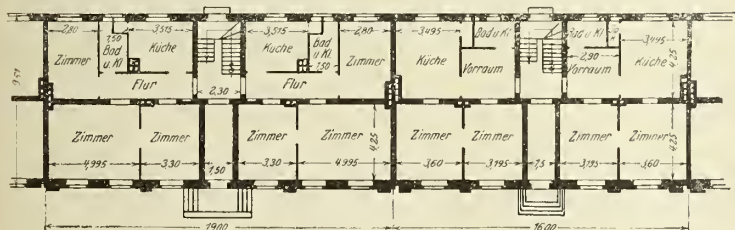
Zweigeschossige Vierfamilienhäuser. Erdgeschoß.
